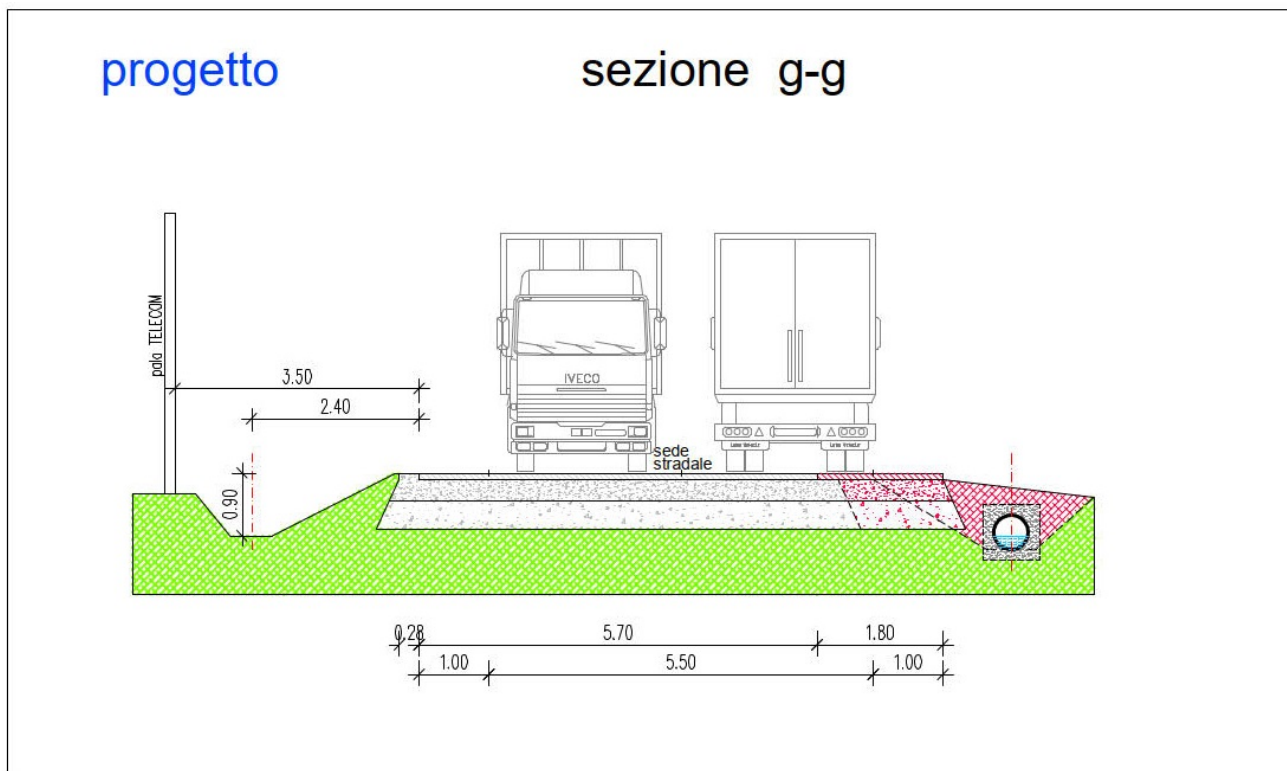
VIA CARPI - riqualificazione e allargamento Via Carpi SEZIONE TIPO
